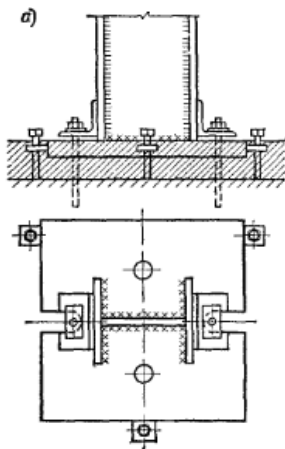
Типова база колони з фрезеруванням торцю
